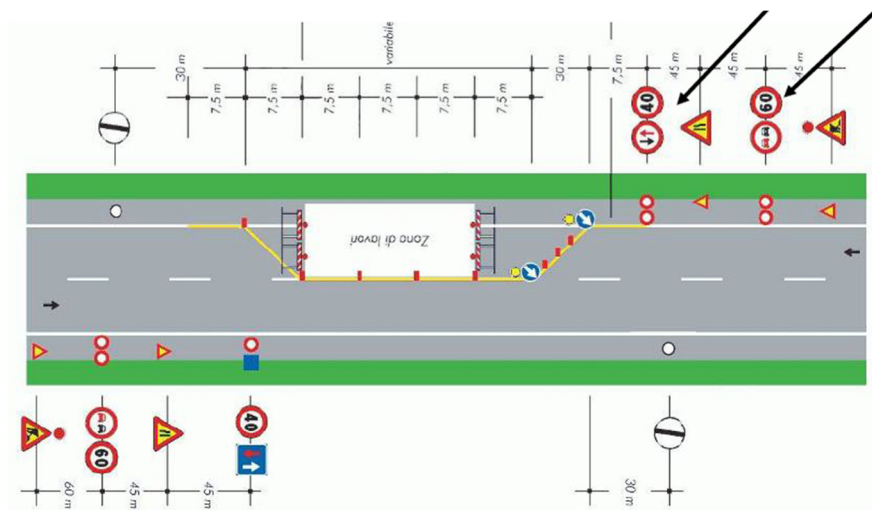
Esempio cantiere stradale con limitazione della velocità con senso unico alternato a vista
